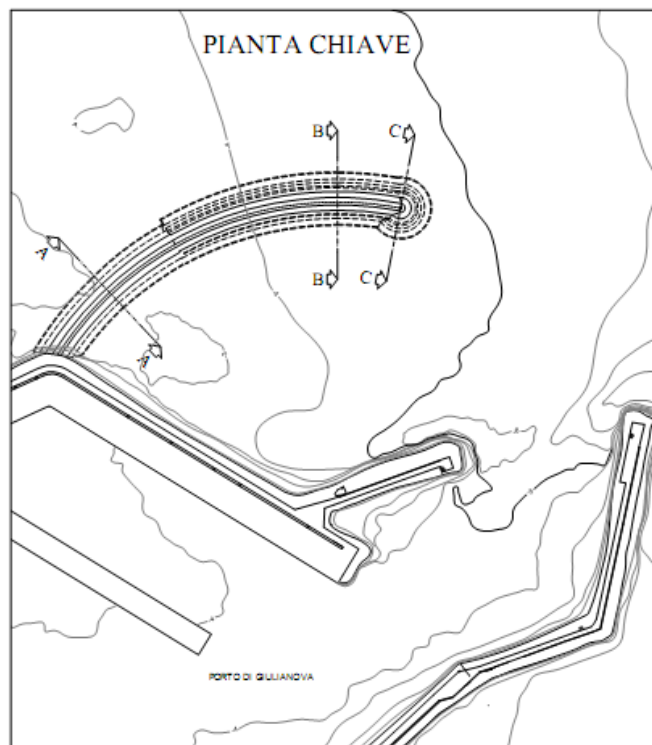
Planimetria della diga nord di sopraflutto (ubicazione delle sezioni tipo riportate in fig.1)
